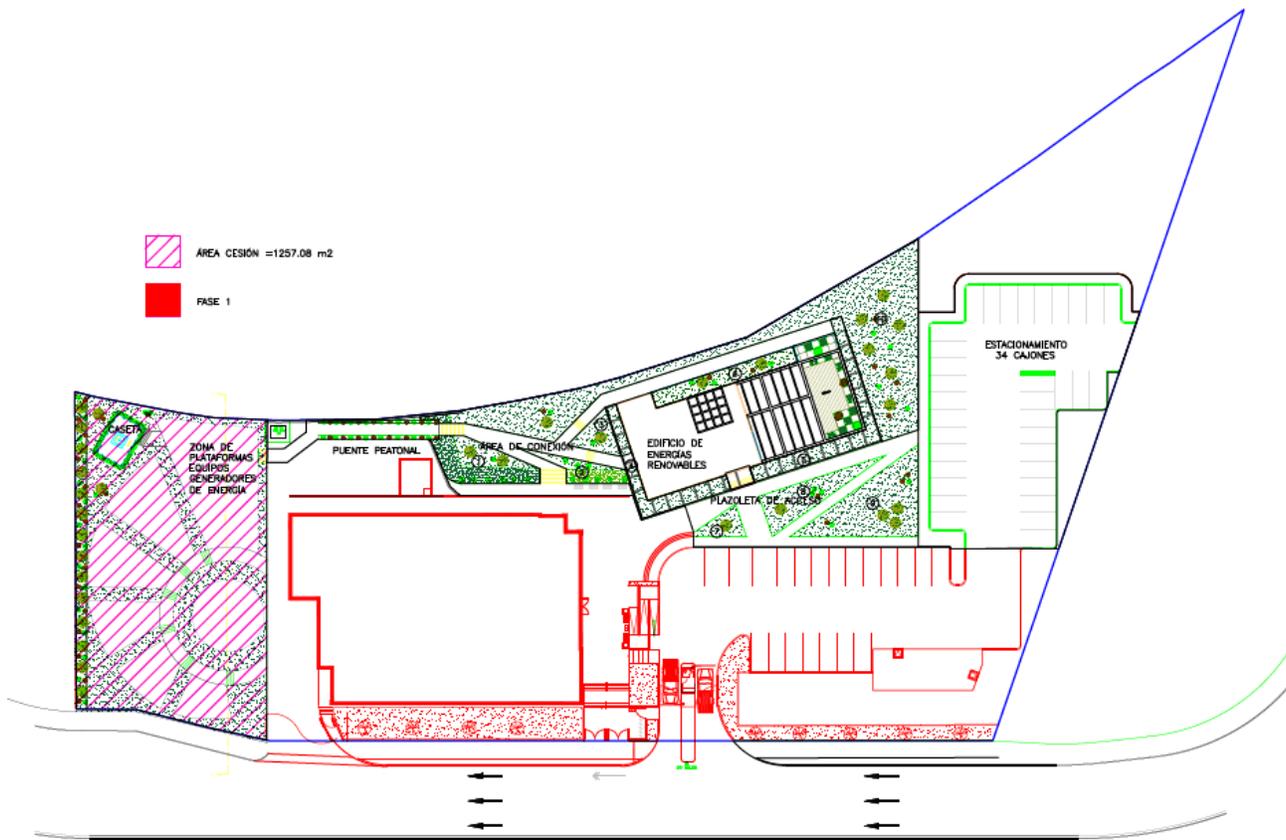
Planta de conjunto del proyecto Fase II, en el Municipio de Zapopan, Jal.
